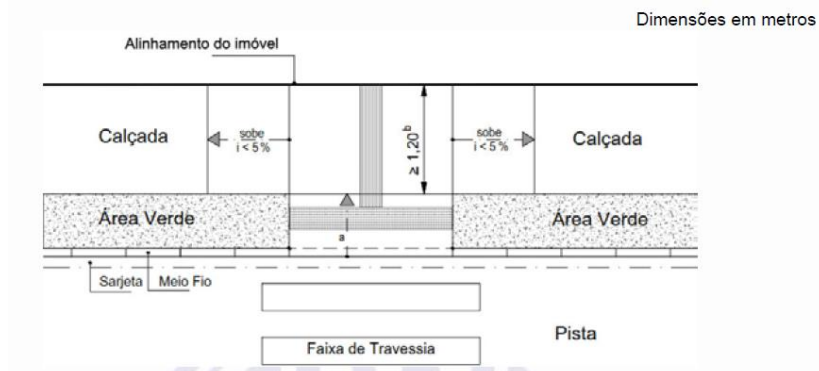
Rebaixamento de calçada entre canteiros – Exemplo
